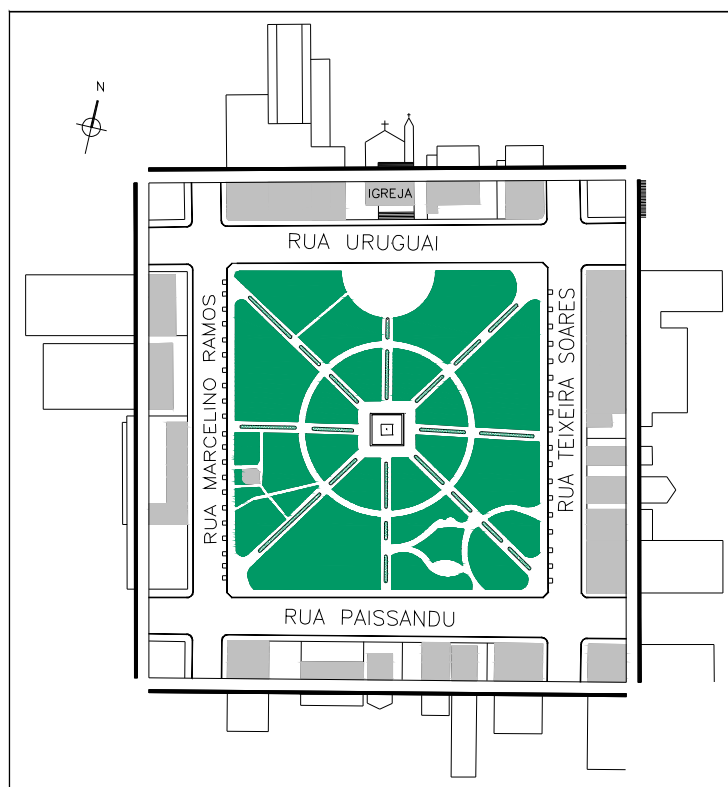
Planta Baixa da Praça Tamandaré e entorno
